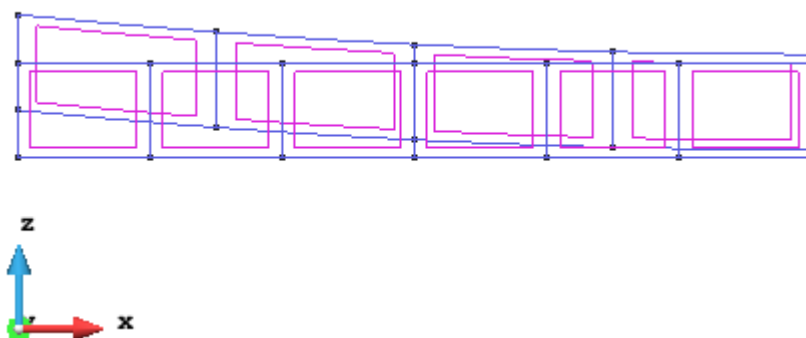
Geometria do cabo e malha da malha de concreto na borda inferior da laje.
